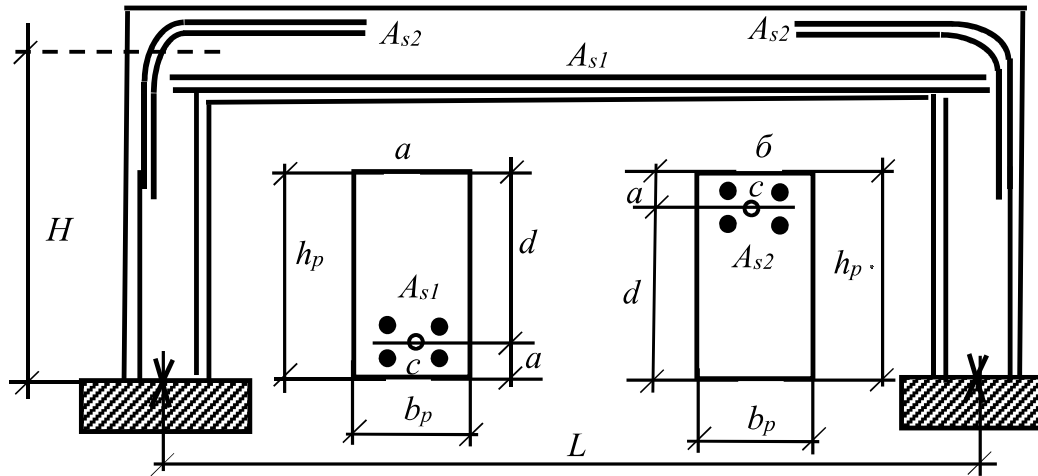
Схема армування ригеля рами поздовжньою розтягнутою арматурою: *a* – схема армування поперечного перерізу в прольоті; *б* – те саме, в опорному перерізі; *c* – центр ваги площі поперечного перерізу арматури
